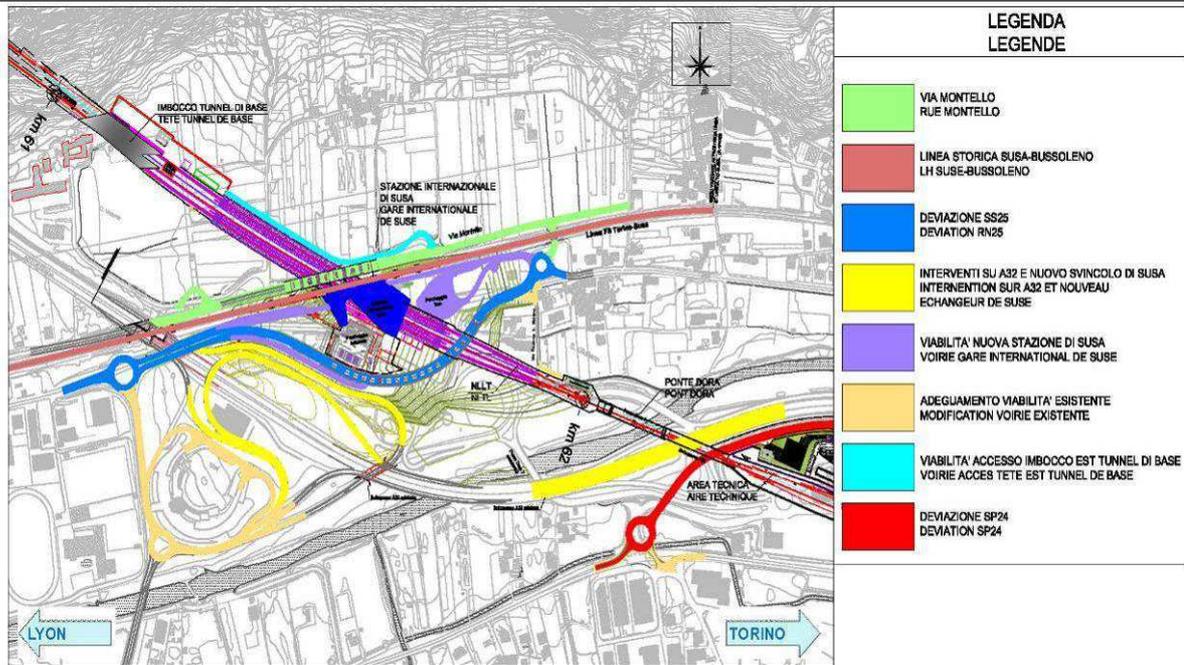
Planimetria viabilità zona imbocco Tunnel di Base – Ponte Dora
